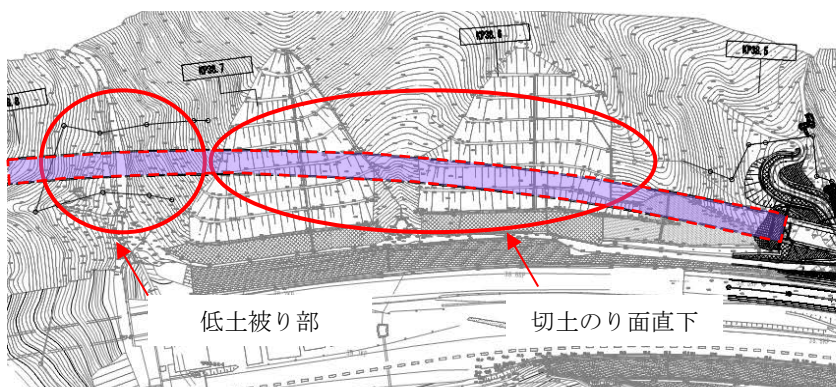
低土被り部および切土のり面の直下での施工箇所平面図
